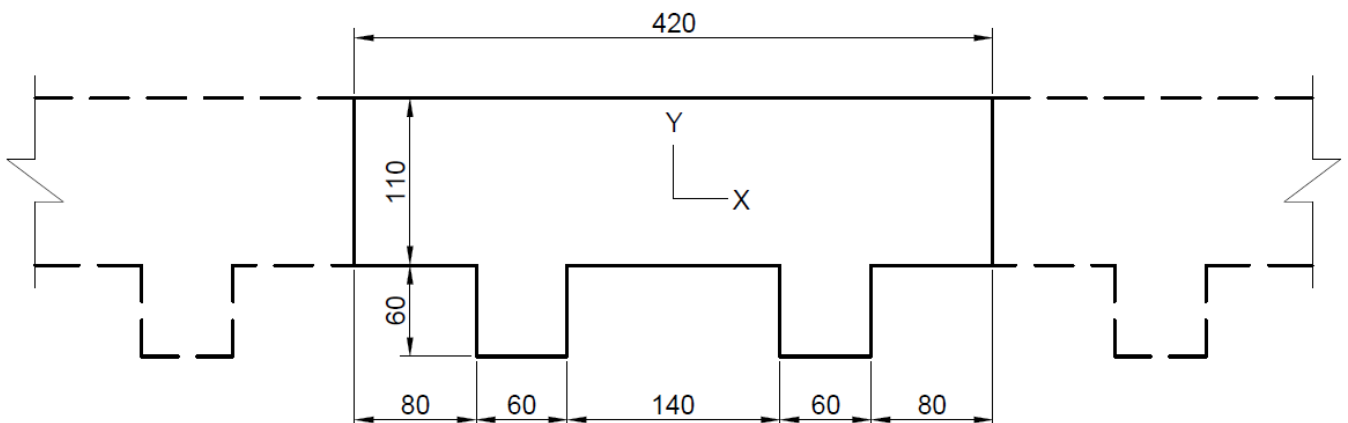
Sección transversal de la losa del forjado de cubierta (cotas en mm)
